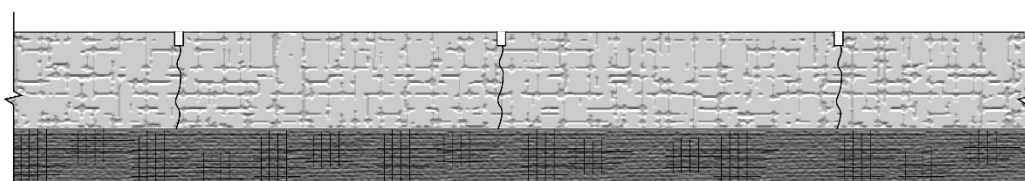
Perfil de pavimento rígido de betão não armado, com juntas (adaptado de OLIVEIRA, 2000)
